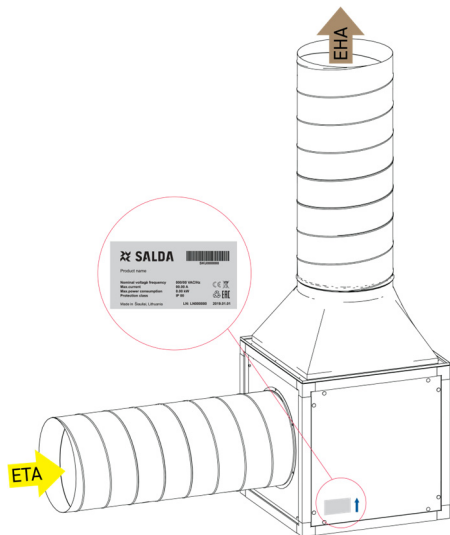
Umístění technického štítku VKS a směr proudění vzduchu
